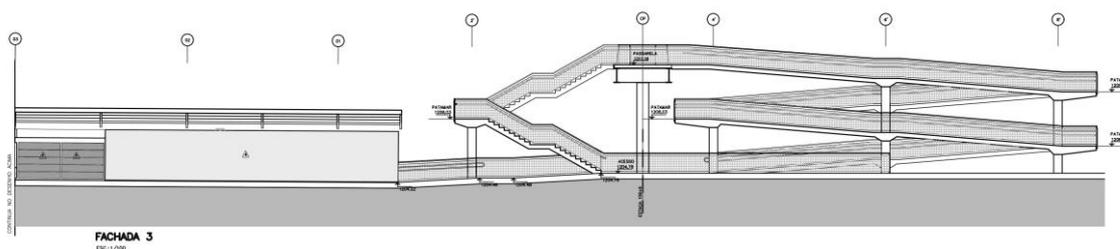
Fachada 3 da Estação 4 do BRT Sudoeste.
